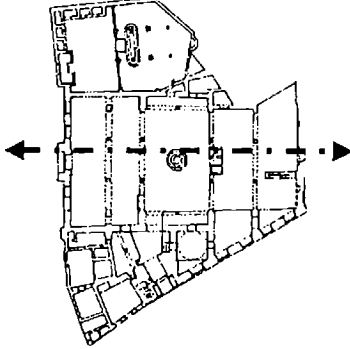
مسقط أفقي جامع شيخو [115:161]
